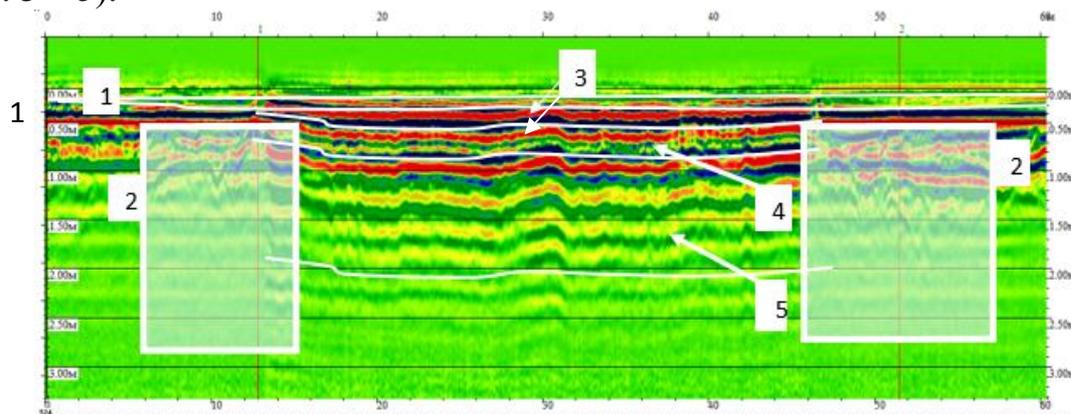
Профиль 1 от 09.09.2021. 1 – асфальтобетон толщиной 100 – 200 мм (имеются наплывы); 2 – железобетонные устои с насыпным грунтом до глубины 1,25 – 1,4 м; 3 – защитный железобетонный слой толщиной 300 - 350 мм; 4 – монолитный выравнивающий слой 350 - 400 мм; 5 - балки моста высотой 1700 мм
